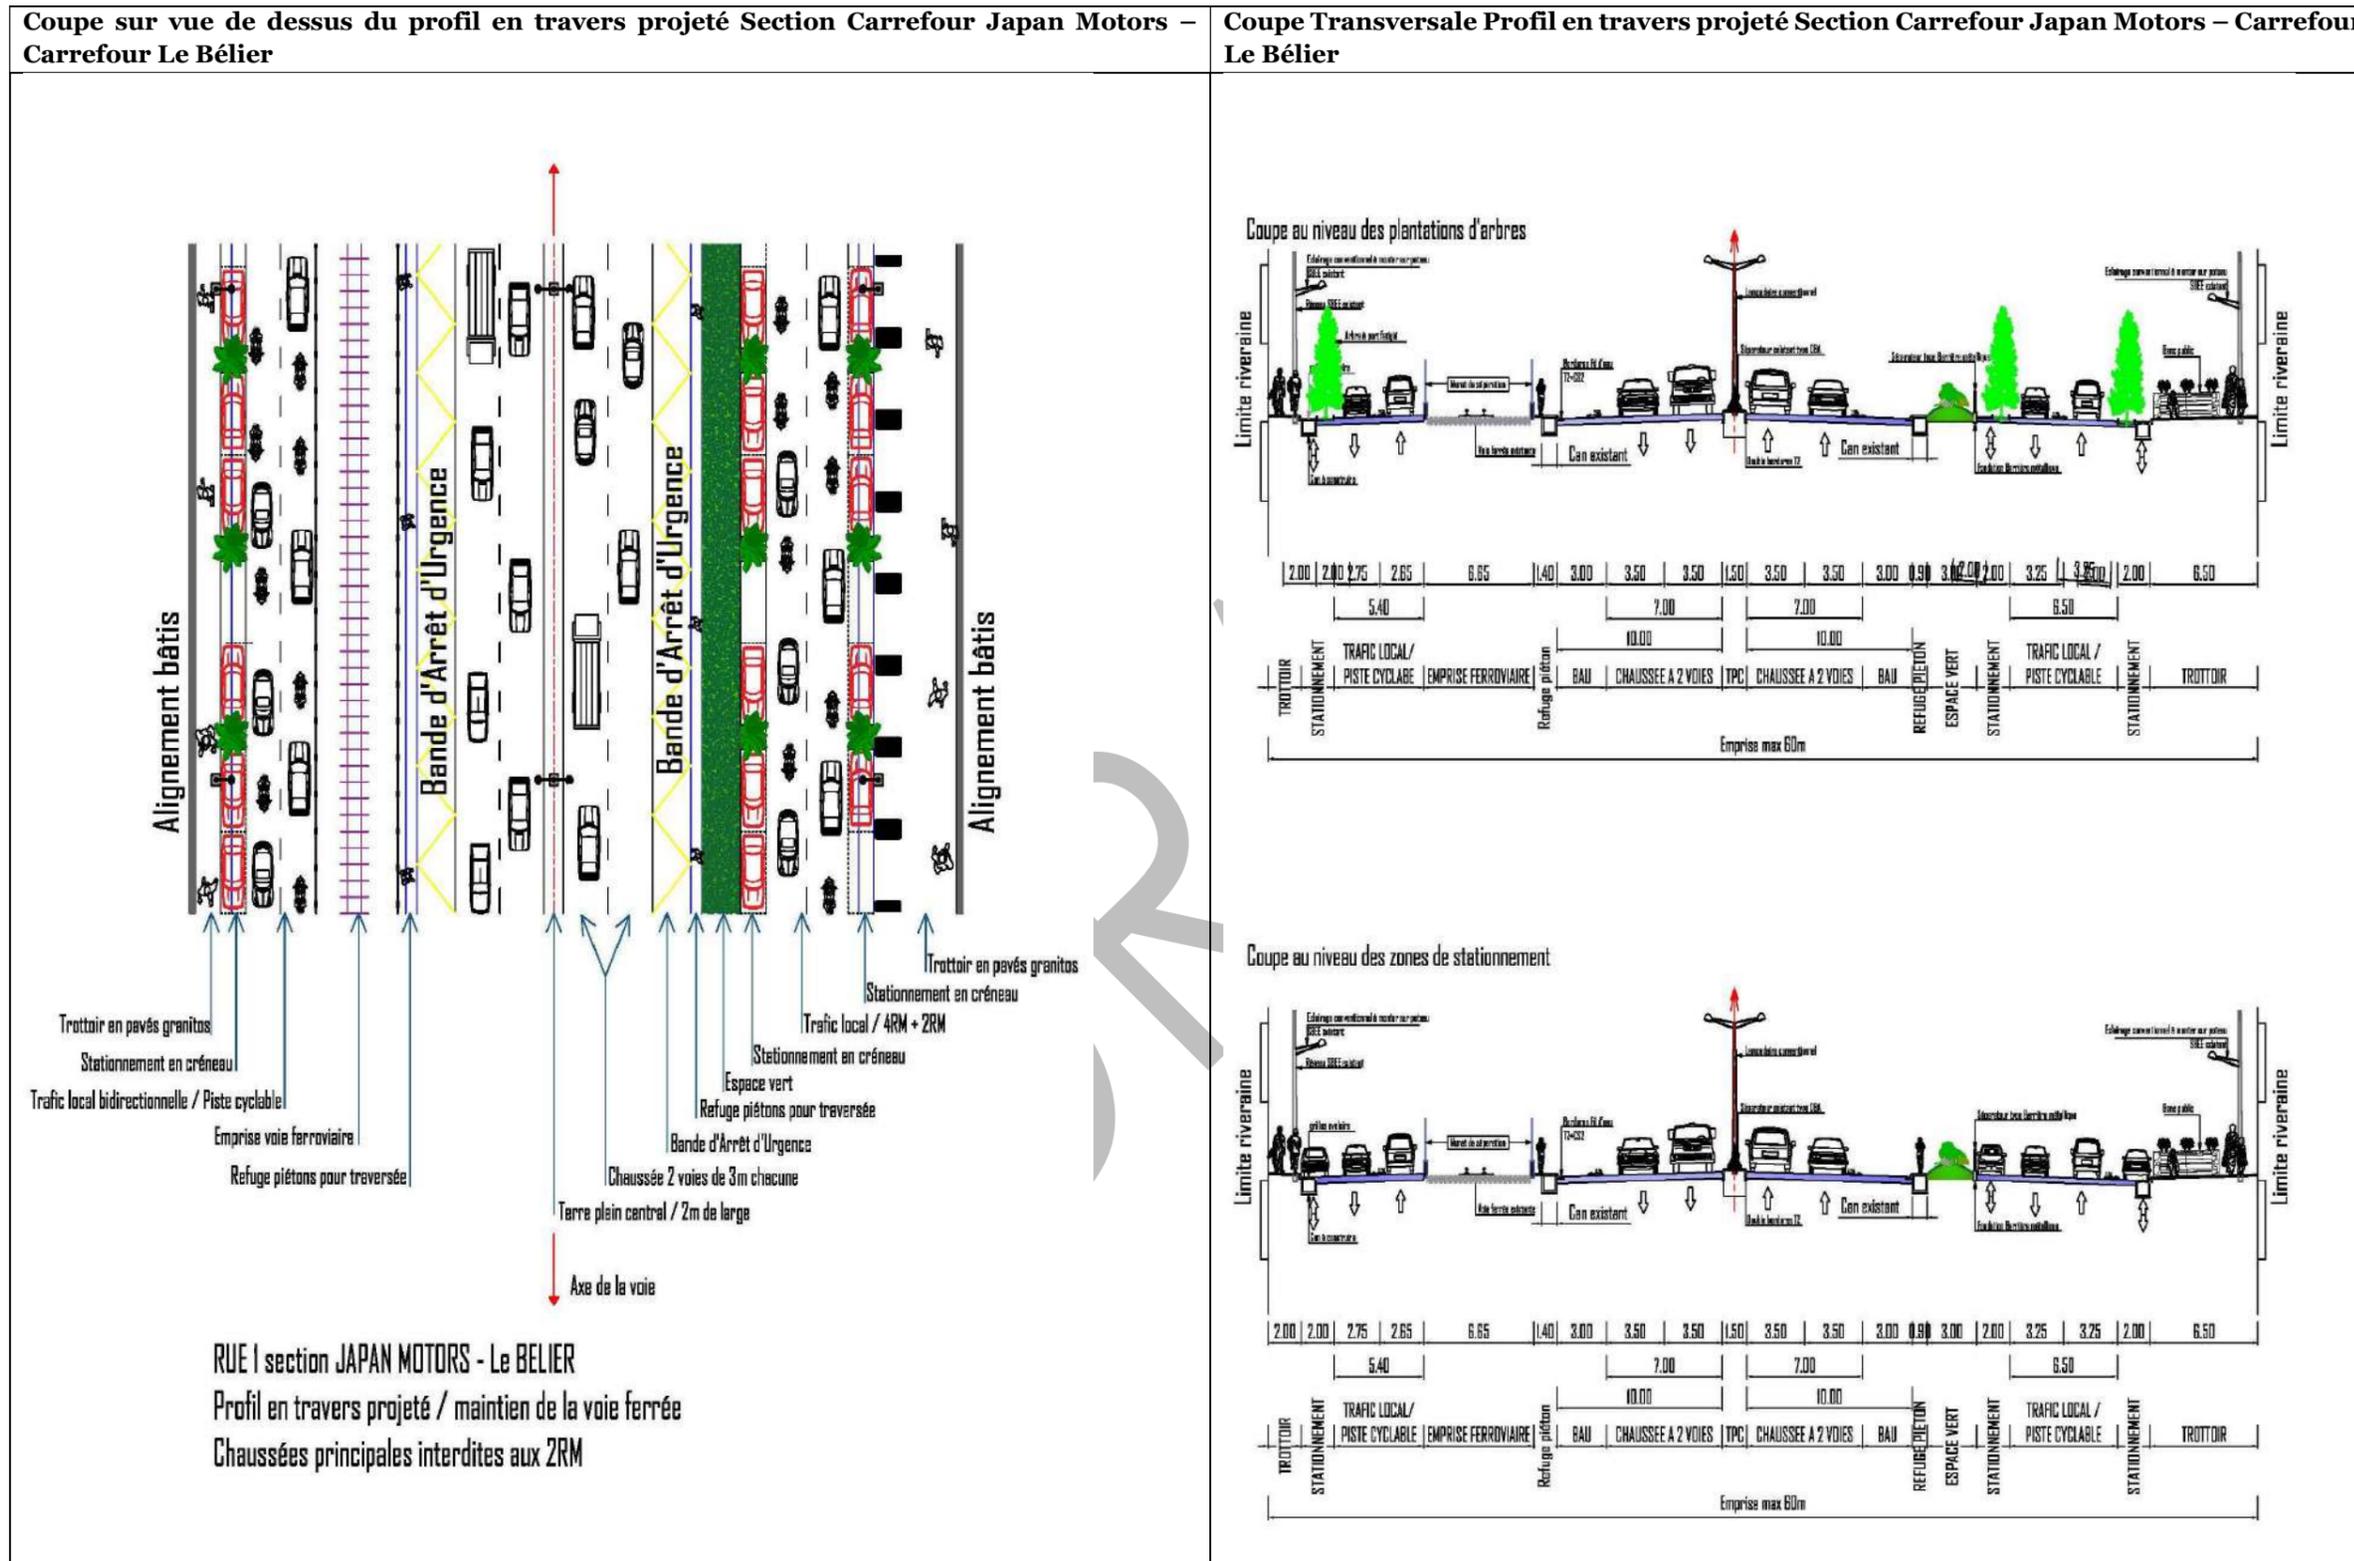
Profil en travers pour la Section Carrefour Japan Motors – Carrefour Le Bélier
